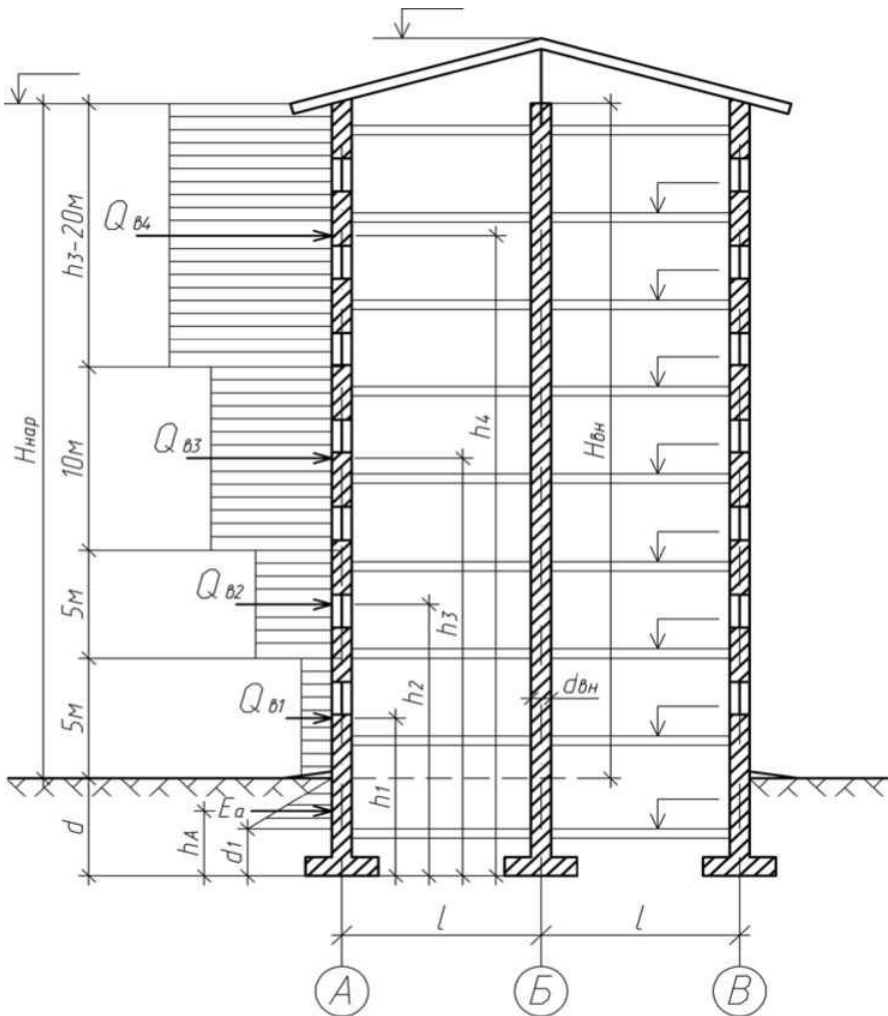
Схема до визначення навантажень на фундаменти.
